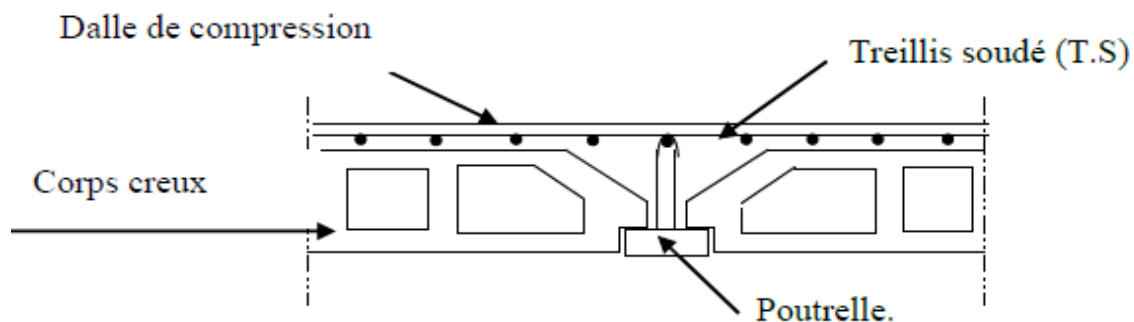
Schéma descriptif d'un plancher courant.
